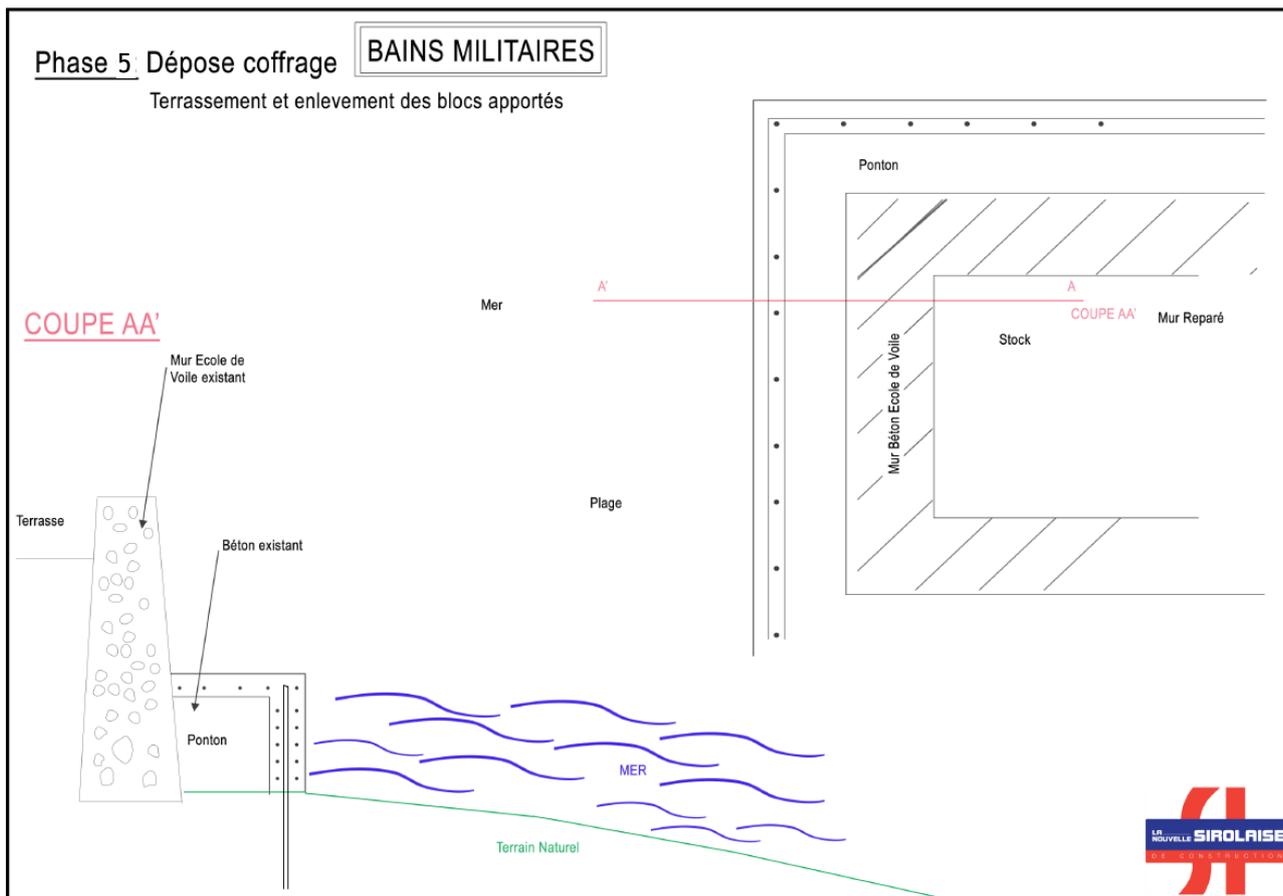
Plan de coupe des travaux de phase 2 - étape 5 (source : La Sirolaise)
